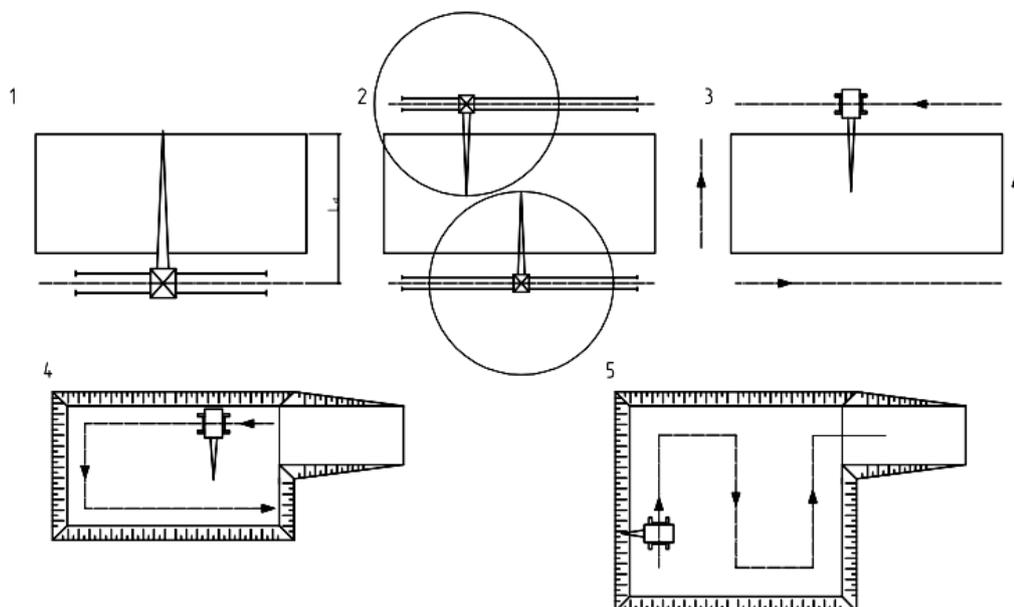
Схема устройства фундаментов многоэтажного здания: по первой и второй схемам фундаменты монтируют башенными кранами или кранами-нулевиками; по третьей, четвертой и пятой схемам фундаменты монтируют самоходными стреловыми кранами
